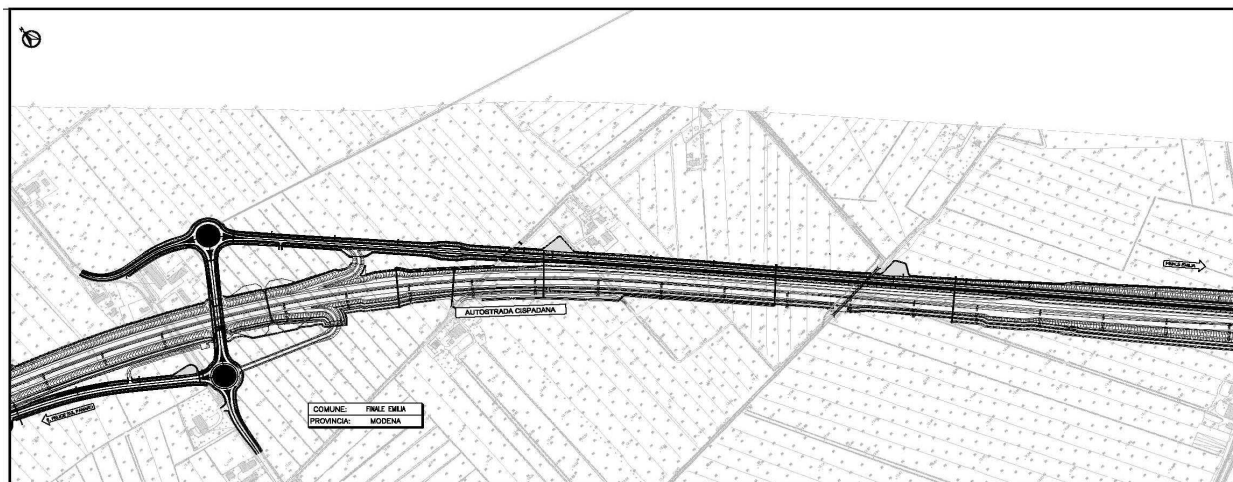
STRALCIO PLANIMETRICO 1 INTERVENTO C08 (EX MO07)
